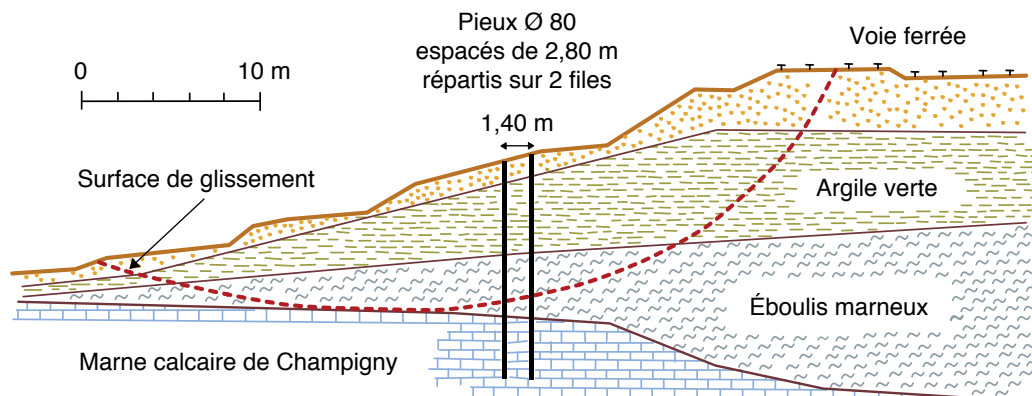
Profil géotechnique du site de Boussy-Saint-Antoine (d'après Cartier, 1986)
